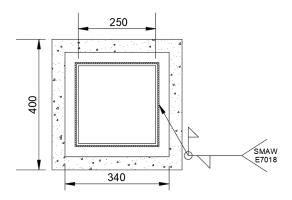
Soldadura de filete en columna y placa base
